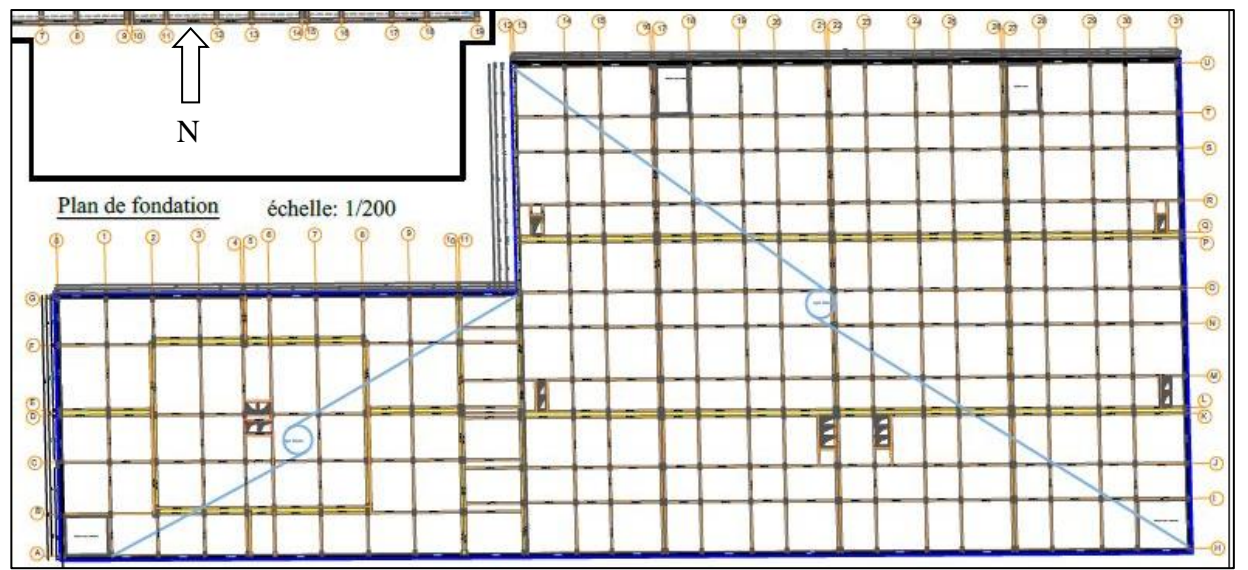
Plan de fondation/Source : Traiter par l'auteur.
